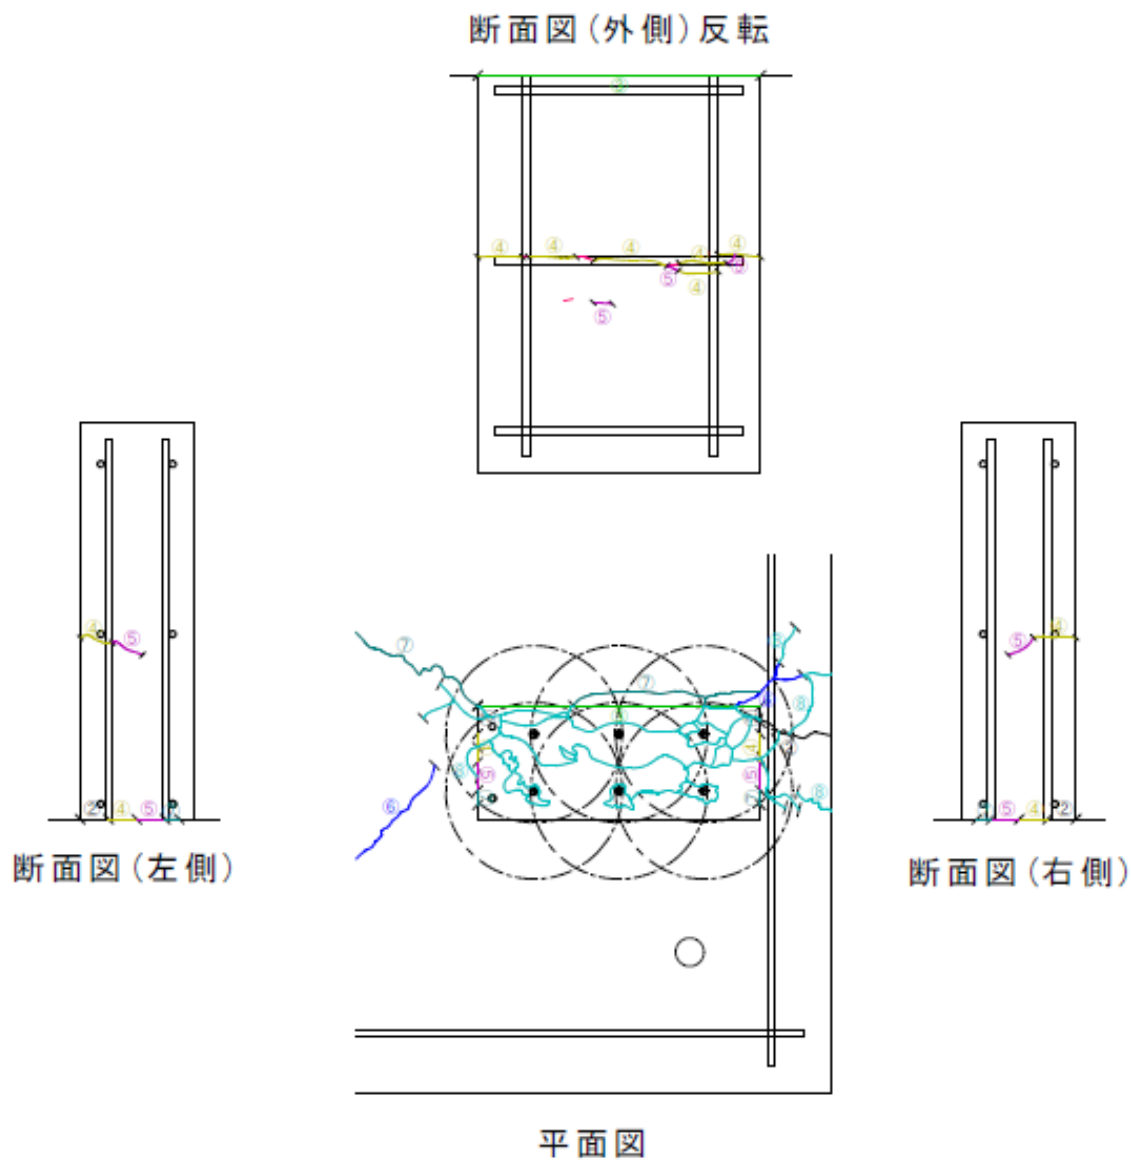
ひび割れ図および最終破壊状況写真 (No.4R)
